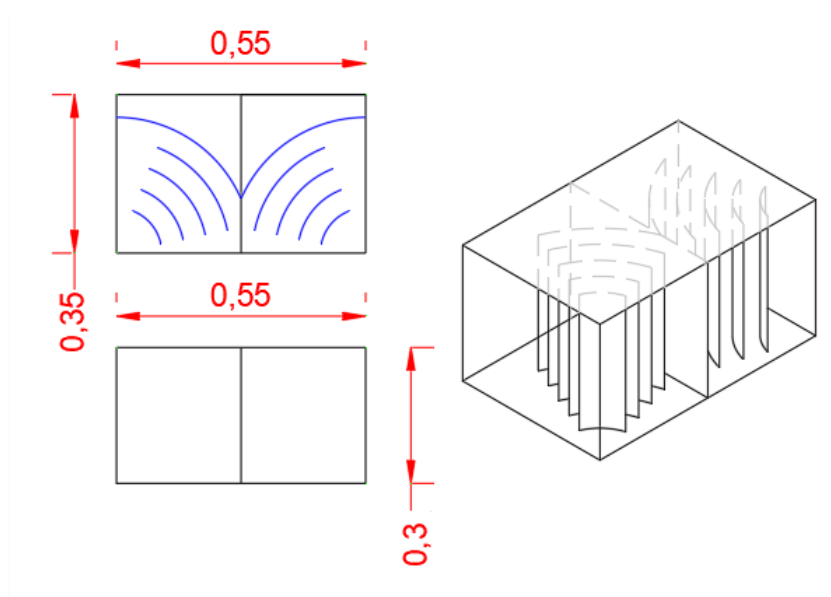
Detalle de caja plenum. Elaborado en AutoCAD.
